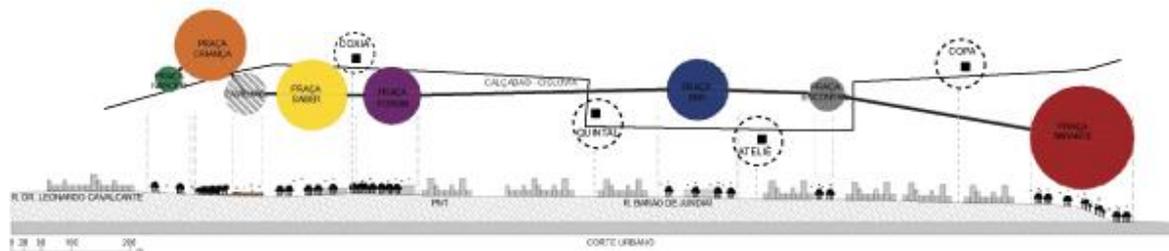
Corte situacional urbano: círculo verde: praça nascer; círculo laranja: praça criança; círculo hachurado: pavilhão; círculo amarelo: praça saber; círculo tracejado: edifício coxia; círculo roxo: praça fórum; círculo tracejado: edifício quintal; círculo azul: praça ser; círculo tracejado: edifício ateliê; círculo cinza: praça encontro; círculo tracejado: edifício copa; círculo vermelho: praça aventura. Fonte: Isabela DiMaio; Jéssica Vaccari (2019).
